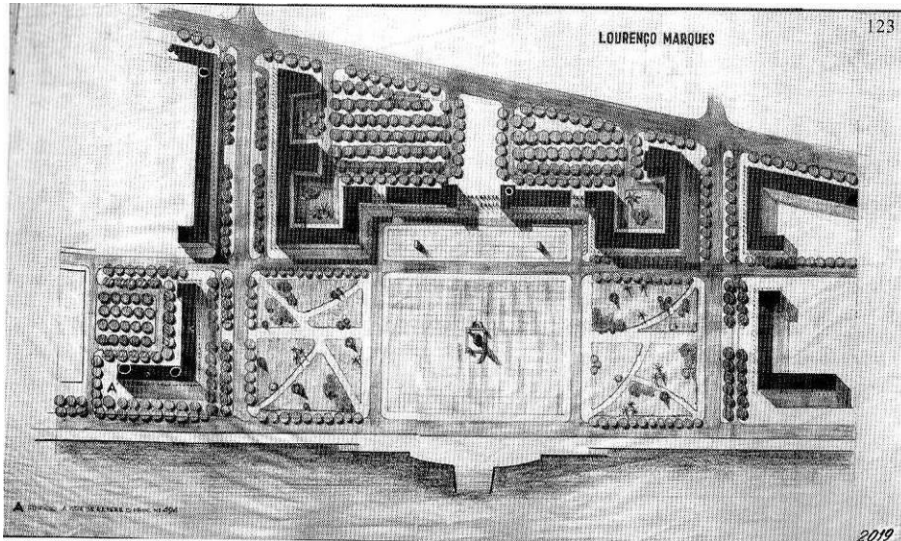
Planta da “Praça do Império” previsto para o centro cívico, 1955 (fonte: Ferreira 2008).
